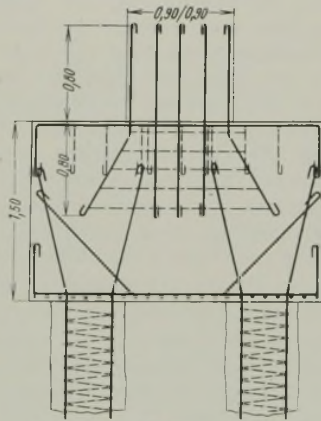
Die Verbindung der Frankipfähle mit den Eisenbetonbanketten nebst Bewehrung.
